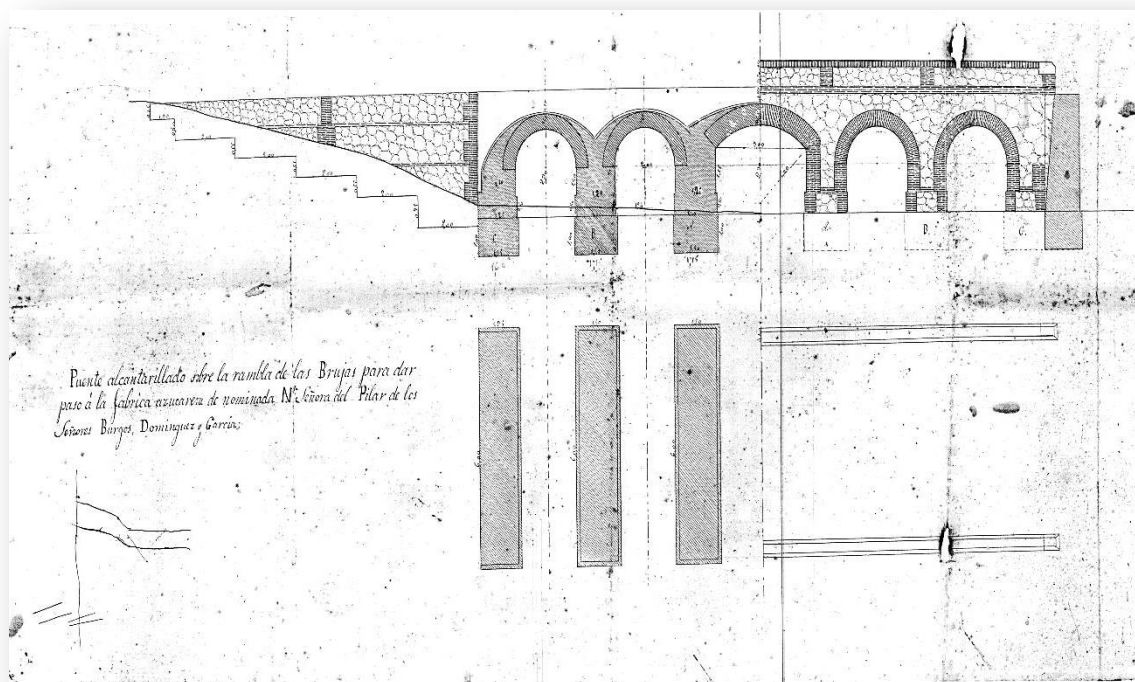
Plano de alzado y fundaciones del puente alcantarillado sobre la rambla de las Brujas de la azucarera de los Srs. Burgos, Domínguez y García. Fuente: SGAE
